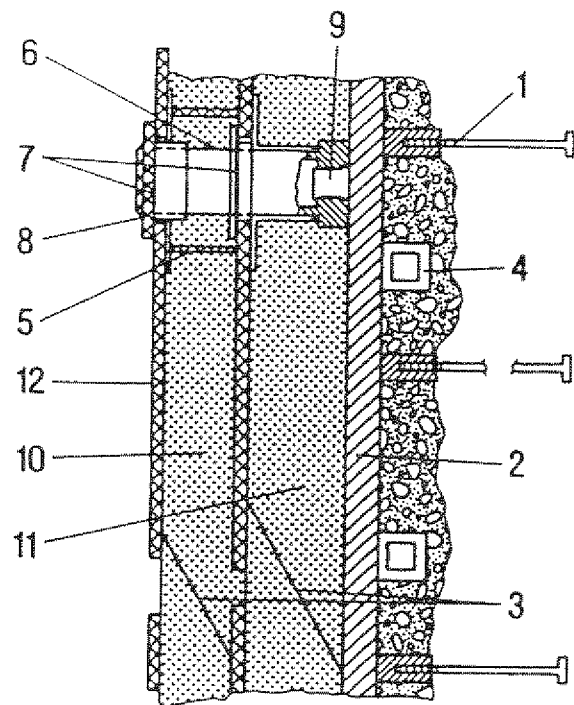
Aufbau des Wärmeschutzsystems mit Keramikfaserisolierung :
